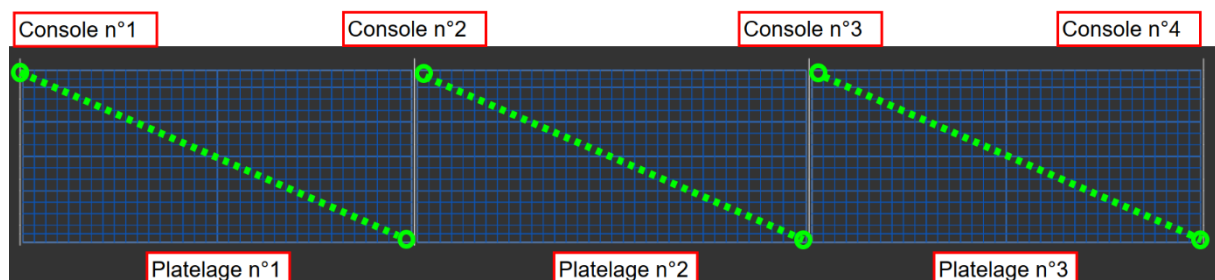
schéma de blocage horizontal des platelages pour garantir le contreventement longitudinal
